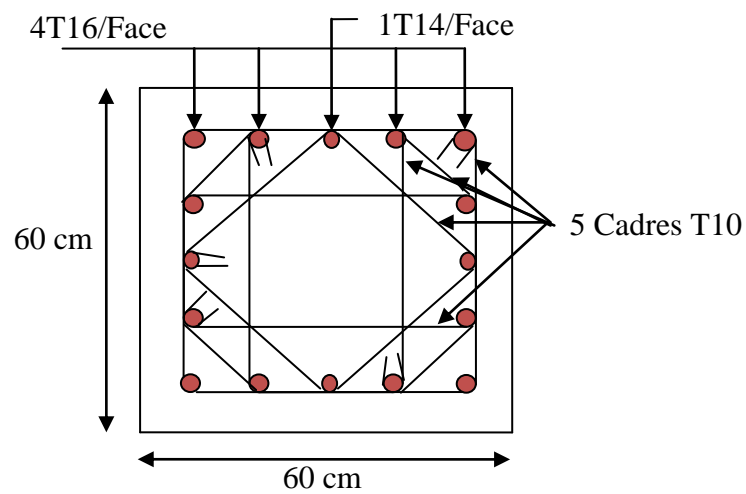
Schéma de ferrailage des poteaux de 1^{er}, 2^{ème} étage
